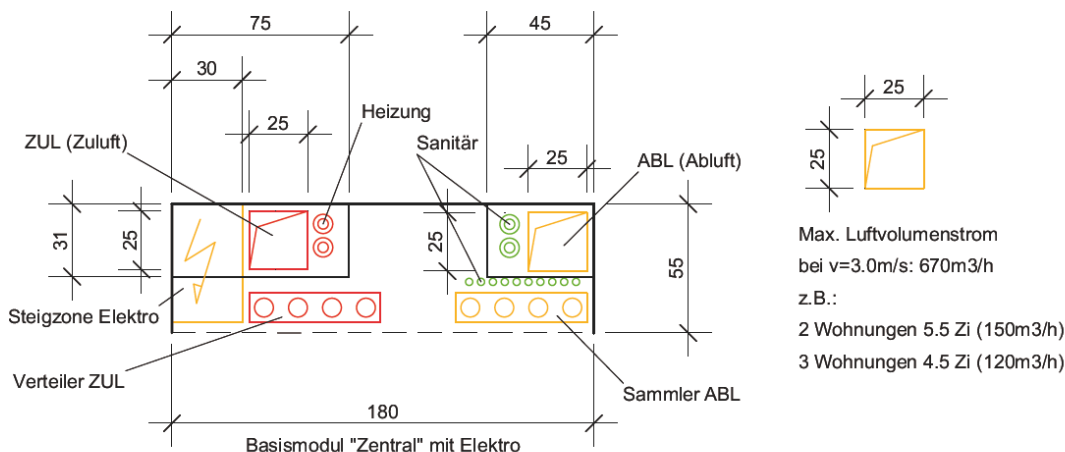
Abmessungen Grundriss Basismodul, Luftaufbereitung je Wohnung
